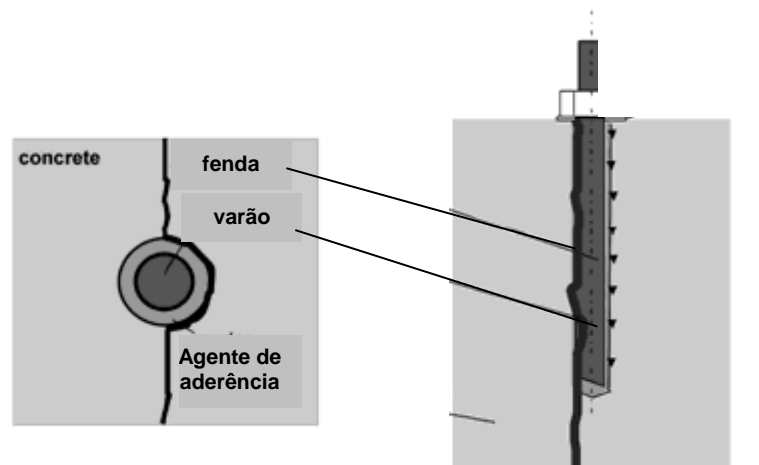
Fissuração do betão junto a uma ancoragem [98].
